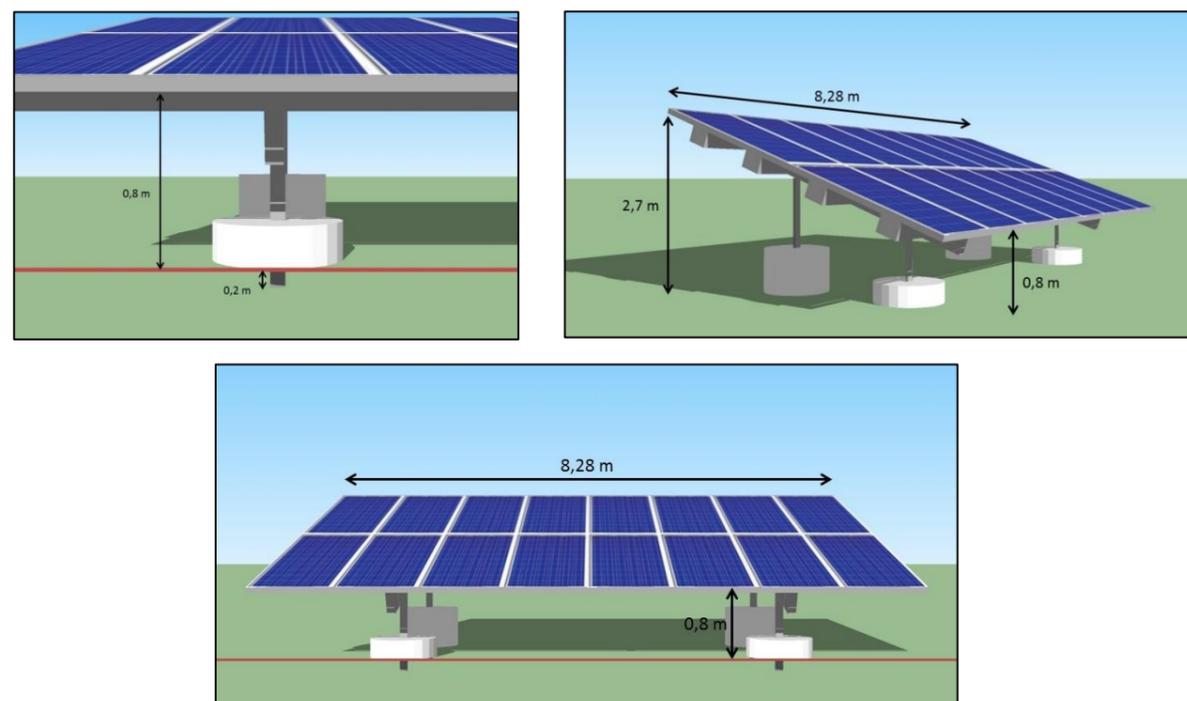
Illustrations 3D d'une structure support avec pieux hybrides
